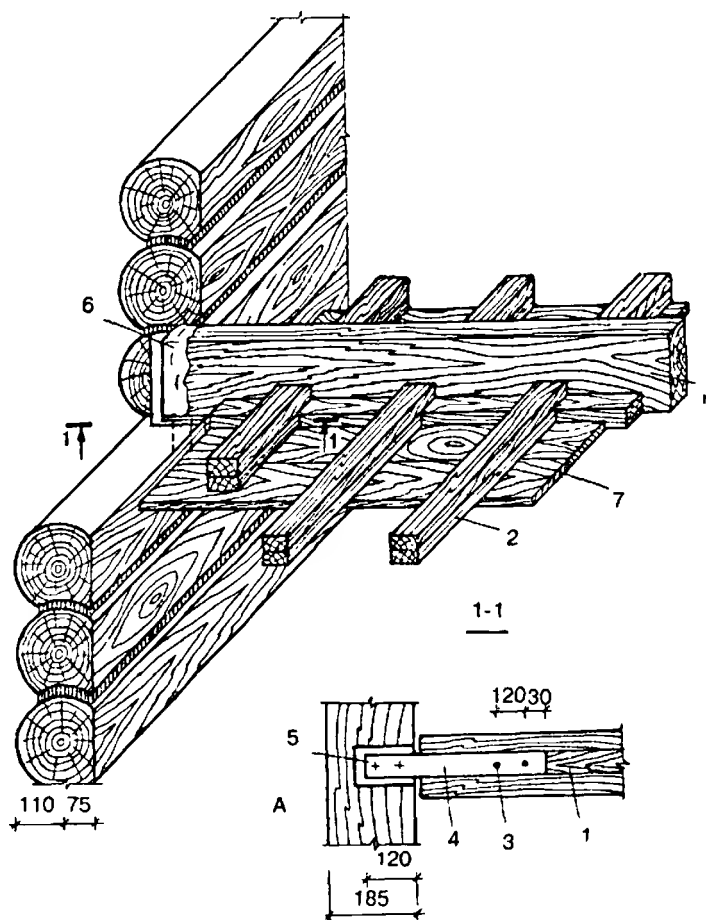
Заделка концов деревянных балок и щитов перекрытия в рубленые бревенчатые наружные стены:
